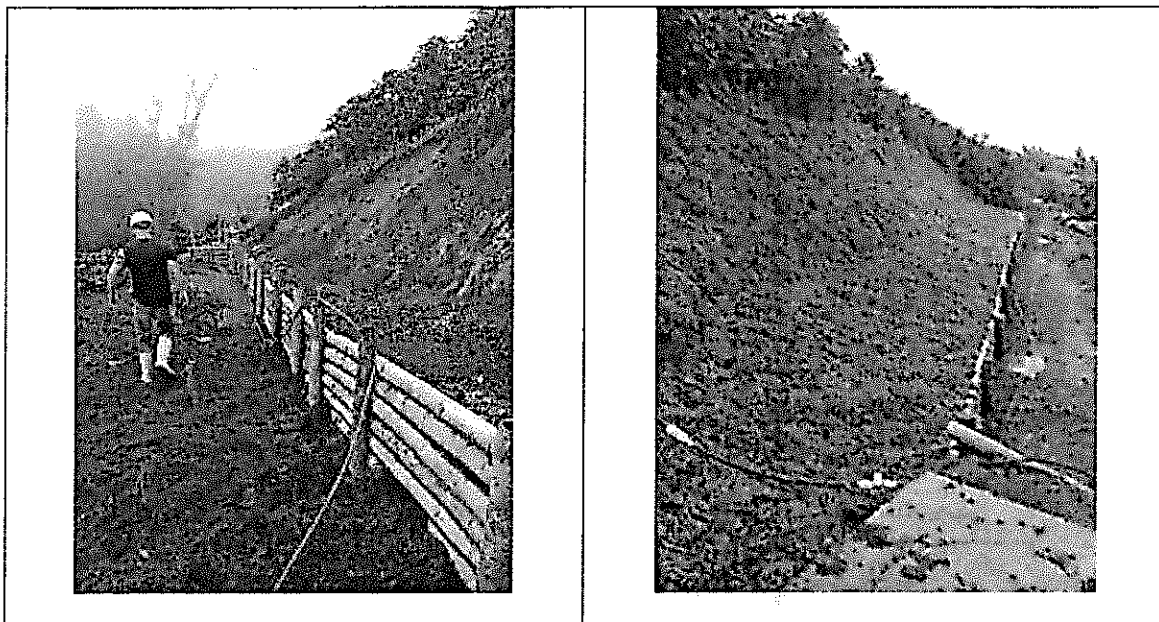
y 20. Construcción Trinchos para estabilizar talud y empradizado
